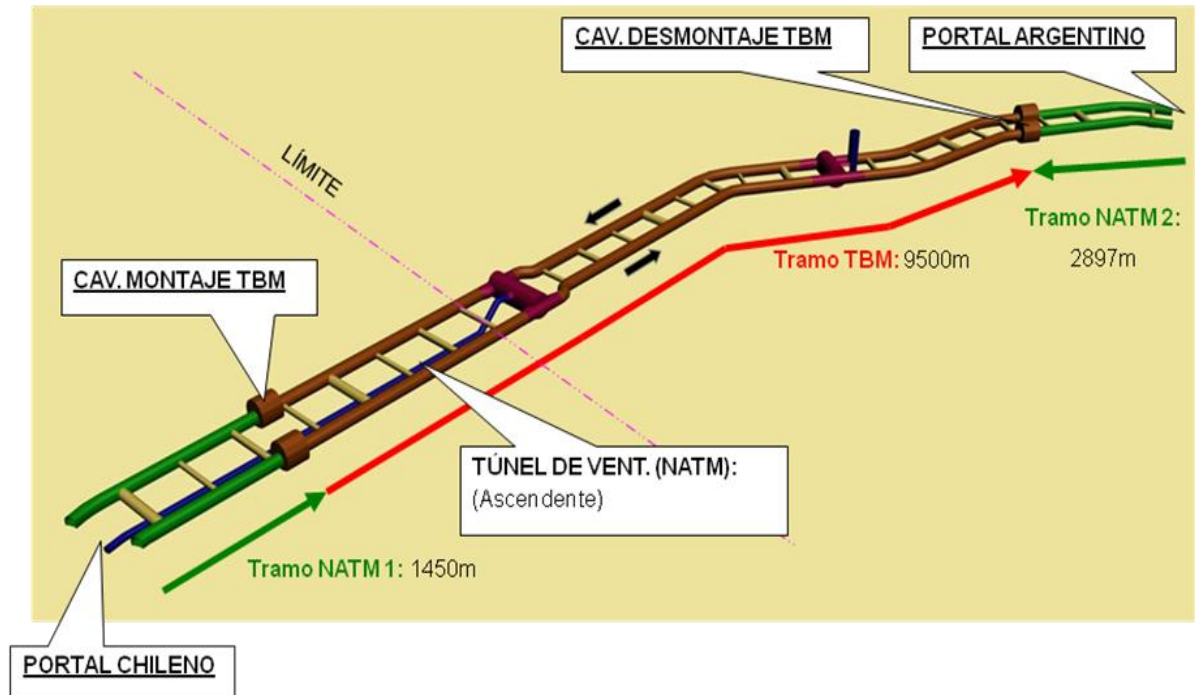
Esquema de Ingeniería básica planteado por Bureau Proyectos
